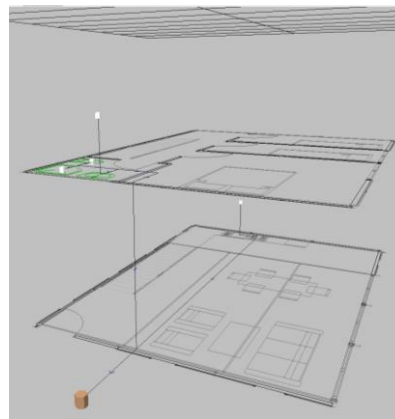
Conexión de saneamiento planta baja y alta de la vivienda de 2 plantas, vista 3D
